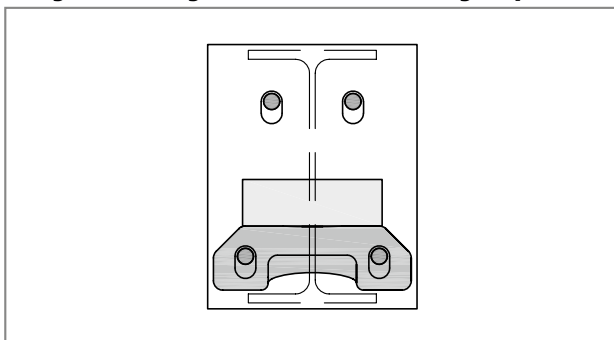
Schöck Isokorb® T type SK: verdraaide en verschoven elementen door onvoldoende fixatie tijdens het beton storten
